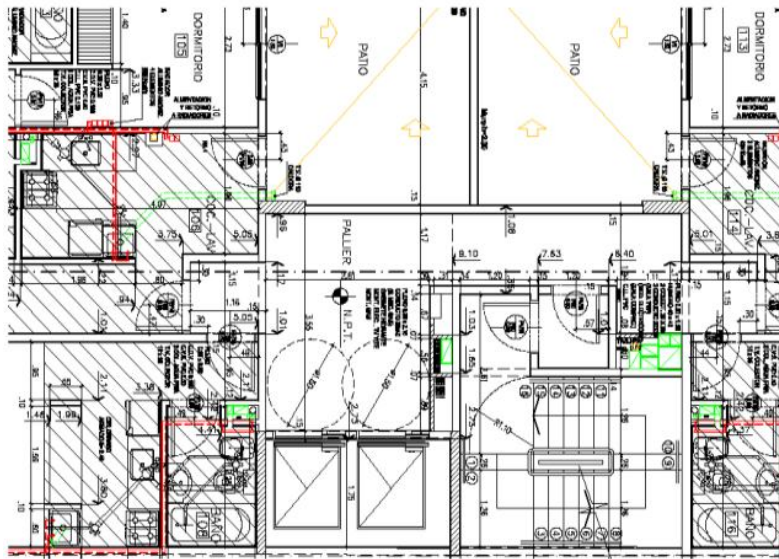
Plano de plantas de viviendas unifamiliar equipadas. Fuente: www.arquitectuba.com
